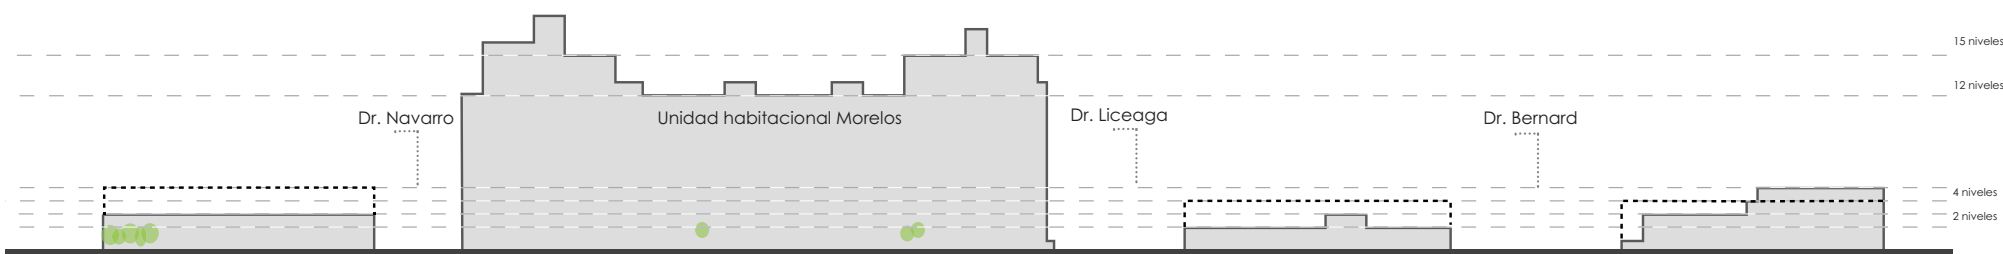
Perfil B - B' Calle Dr. Lucio. Colonia Doctores ¹
